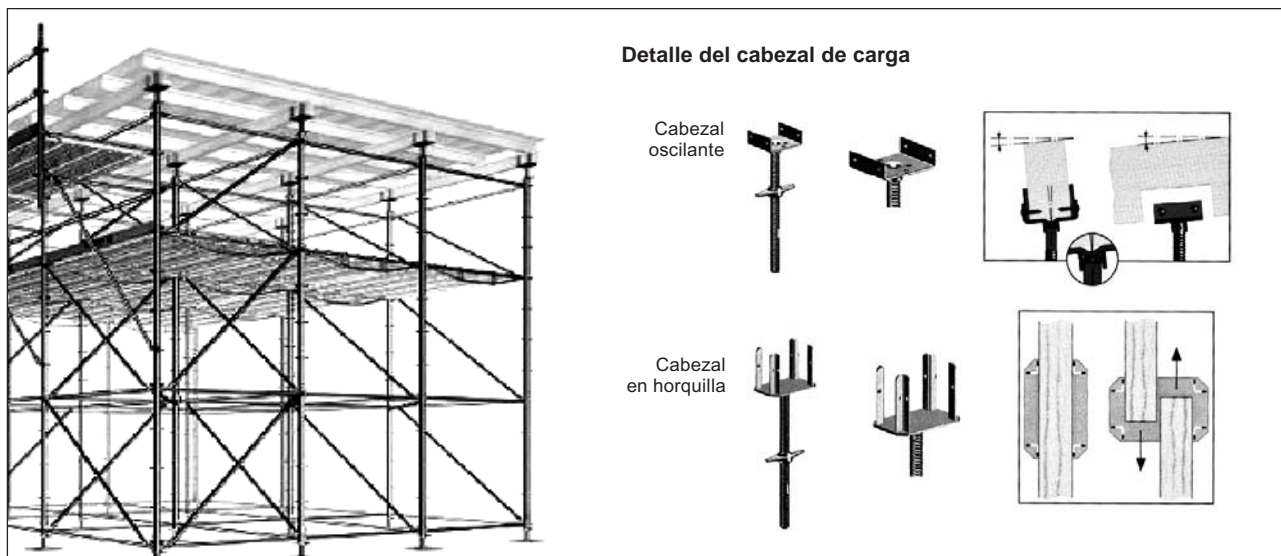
Conjunto de cabezales de carga y correas superiores mediante vigas de madera, sobre sistema de cimbra.
